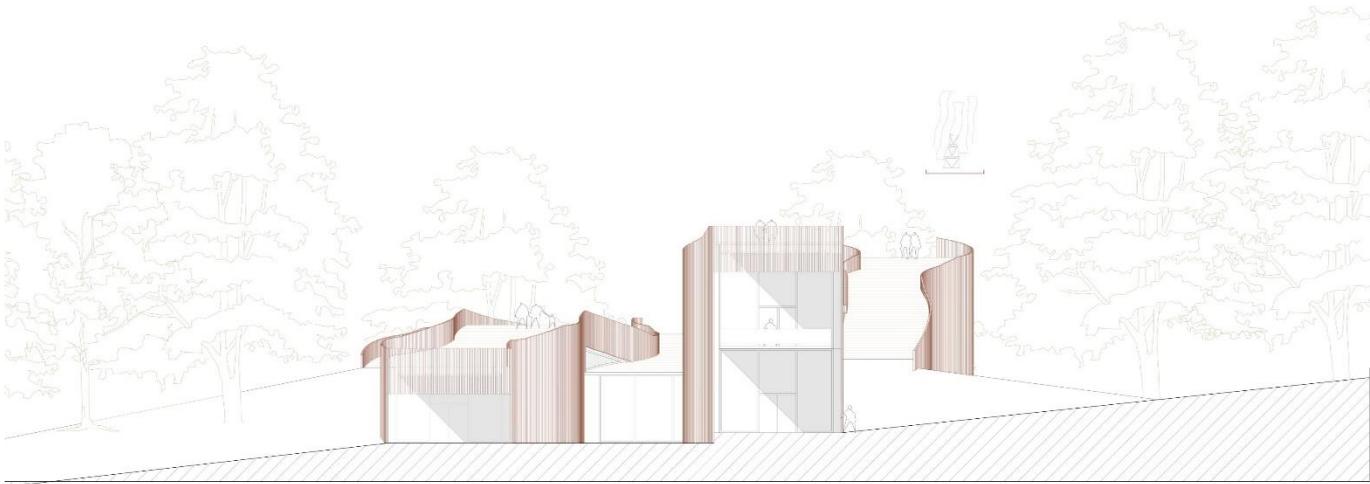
Alzado noroeste. Escala 1:400 Elaboración propia.
